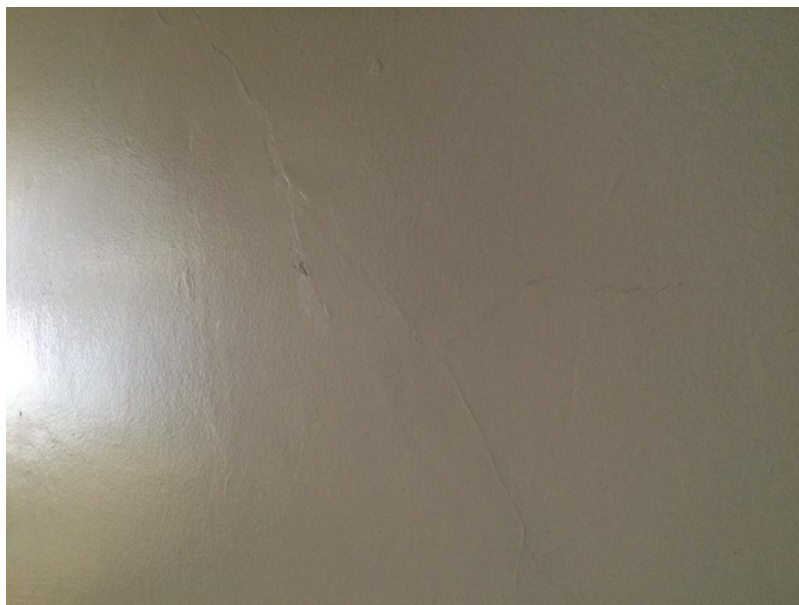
Fisuras por cortante cubiertas con repello
